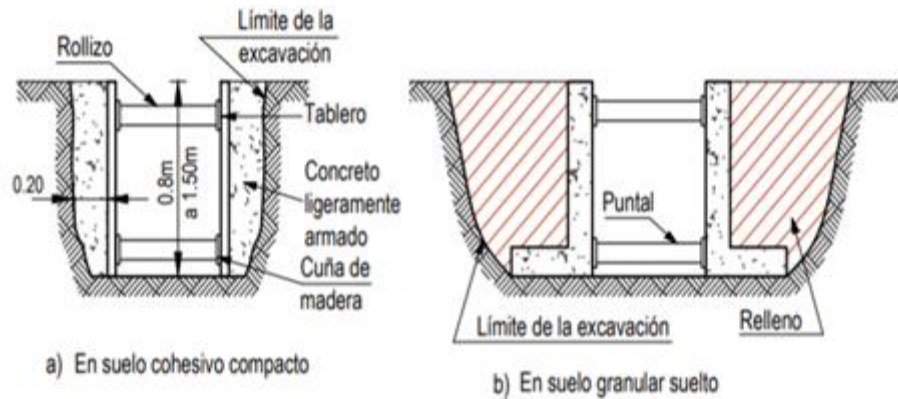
Tipos de “muro guía a) hormigonado contra terreno b) en L Fuente: Criterios y parámetros de diseño de muros pantalla con sistema de anclajes: aplicado en la construcción” de sótanos en Ayacucho (2011).
